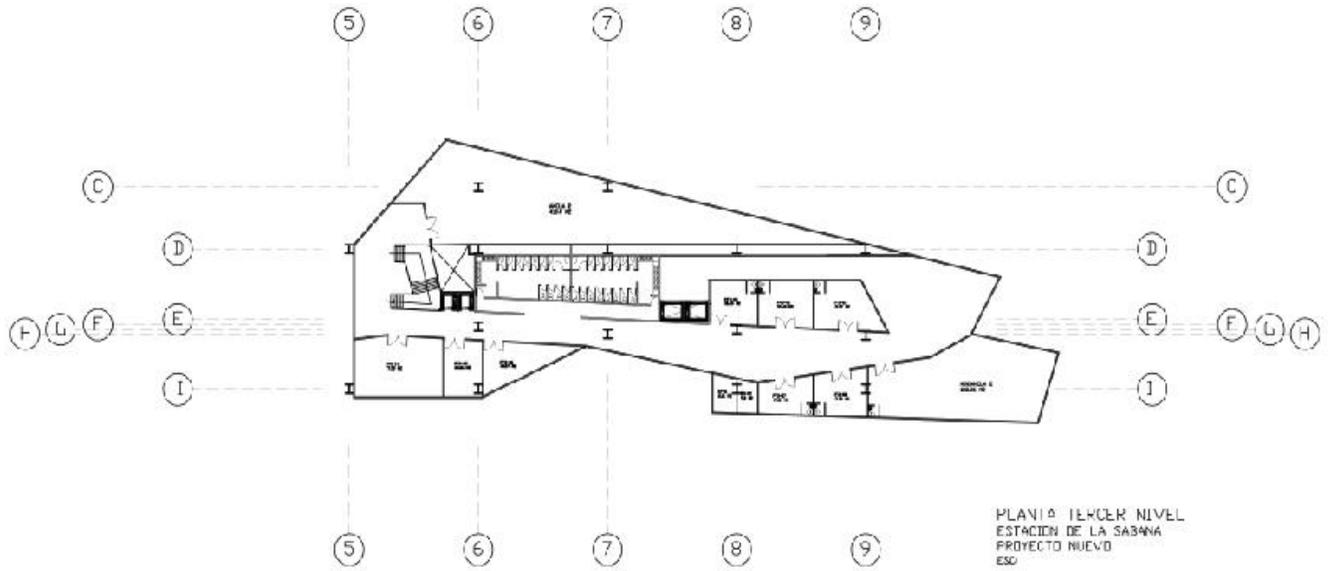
Planta Tercer nivel proyecto nuevo. Estación de la Sabana.
